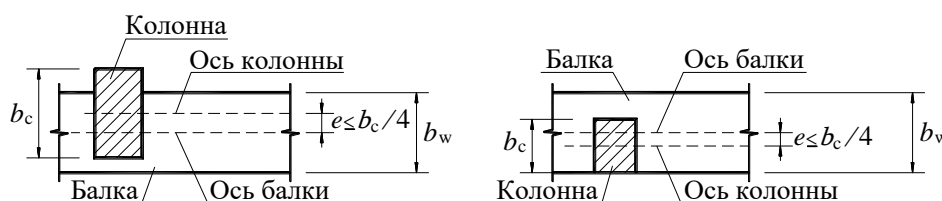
Схемы, характеризующие допускаемые эксцентриситеты между осями колонн и балок
